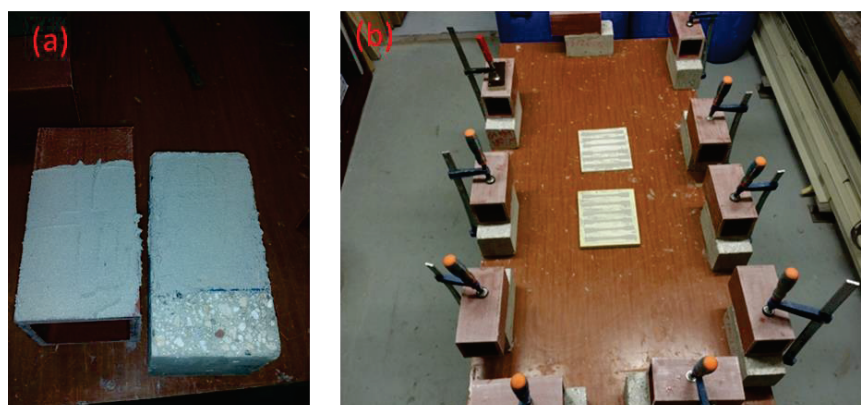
Collage de la première face a) application de l'adhésif sur les surfaces à coller, b) procédé de serrage de la première face
